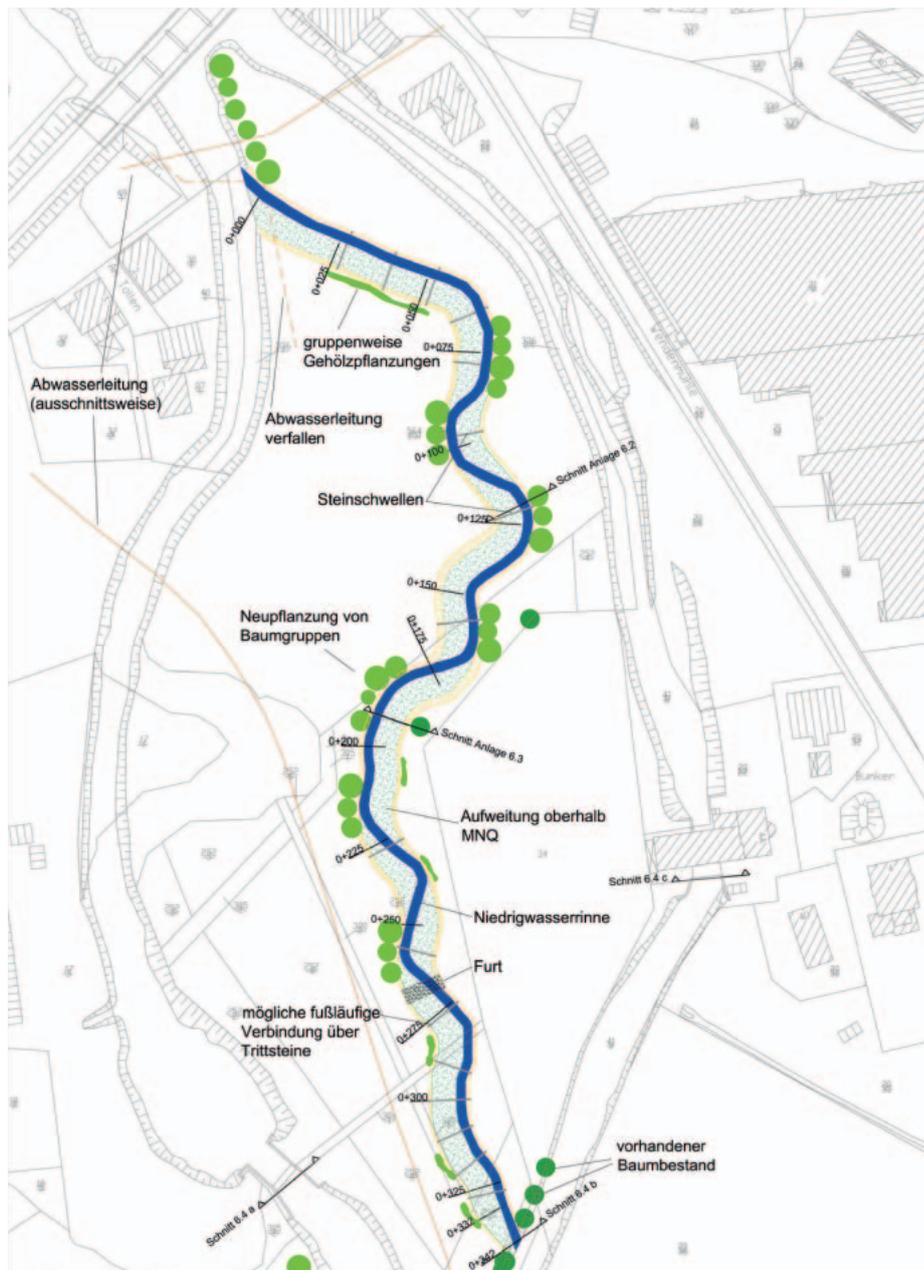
Plan des Raubettgerinnes an der Wendenmühle (Station 26)
